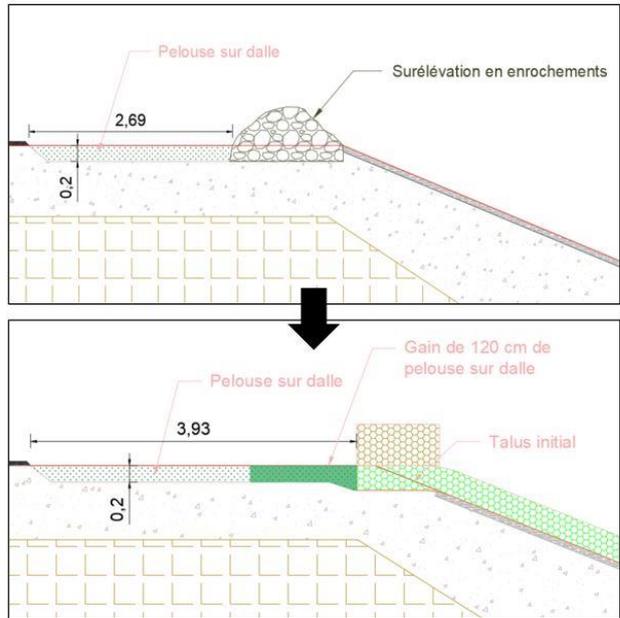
Impact des travaux sur l'habitat « pelouse calcicole sur dalle »
